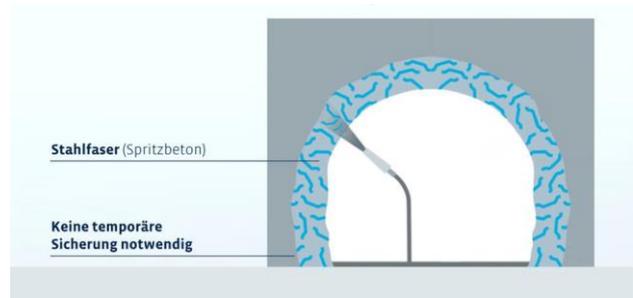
Lösung mit stahlfaserverstärktem Spritzbeton [3]
